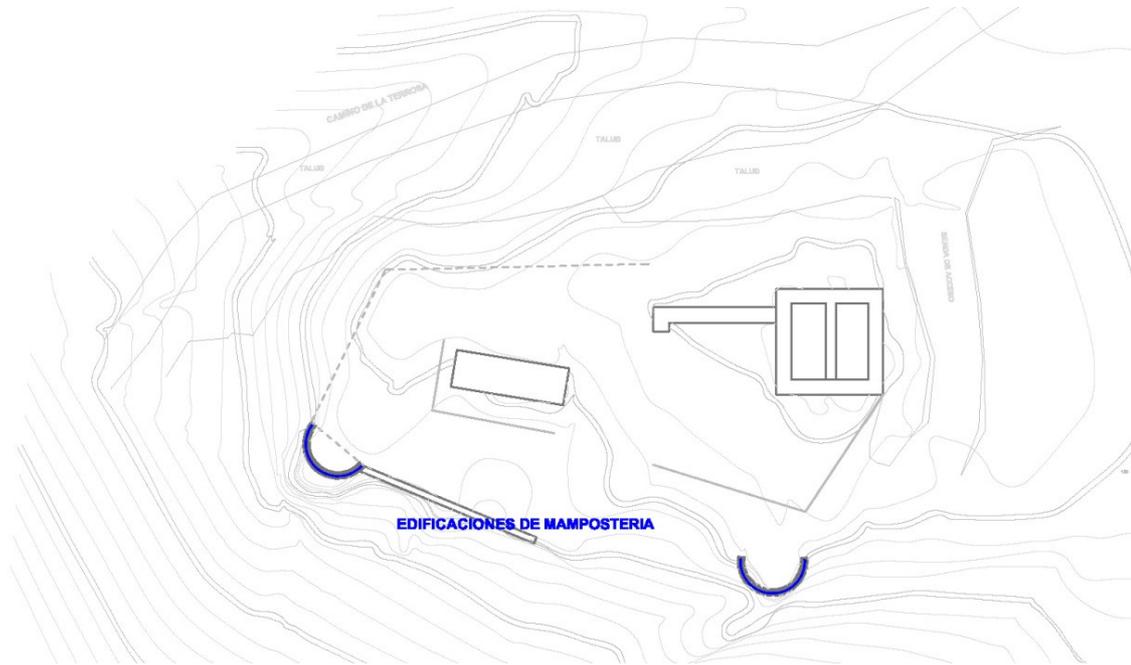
Plano de emplazamiento de las edificaciones de mampostería.
